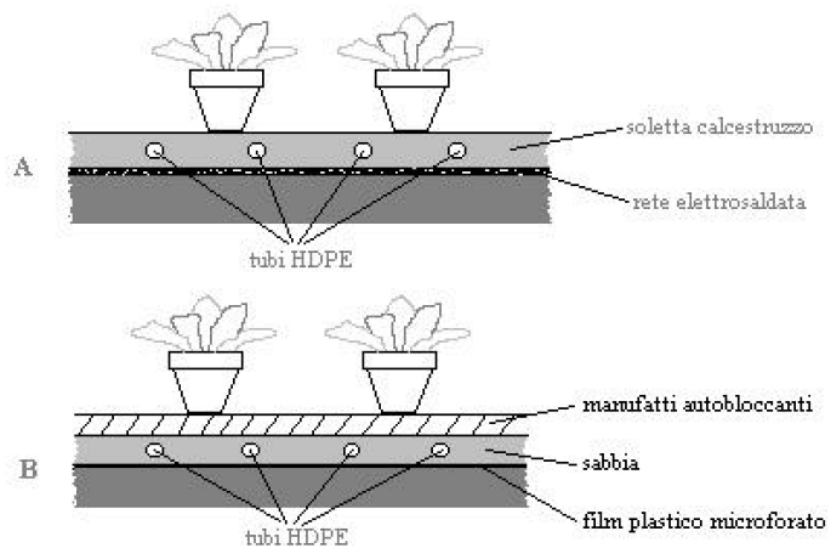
Impianti di riscaldamento a pavimento: A) con soletta in calcestruzzo e tubi annegati, B) con manufatti autobloccanti e tubi nel letto di sabbia
